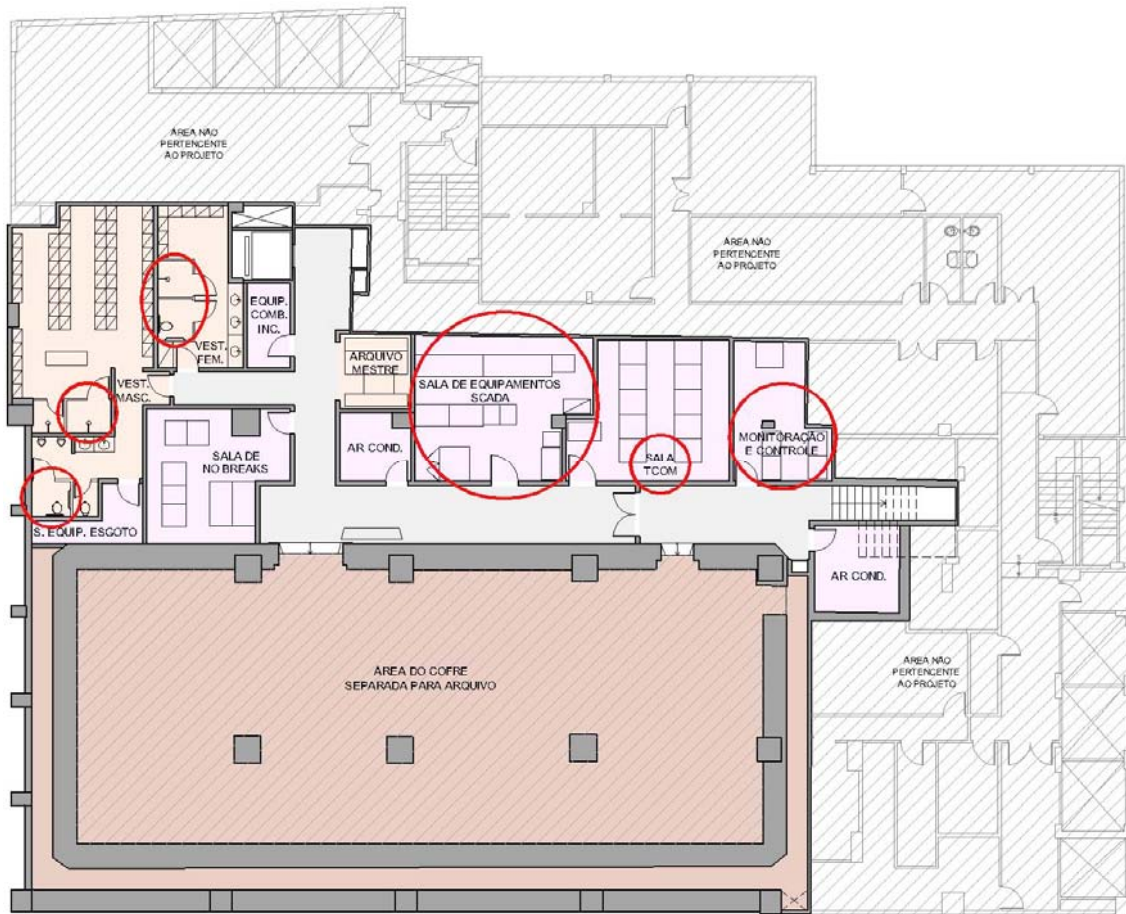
Planta baixa subsolo: layout apresentado como resultado do *milestone 2
